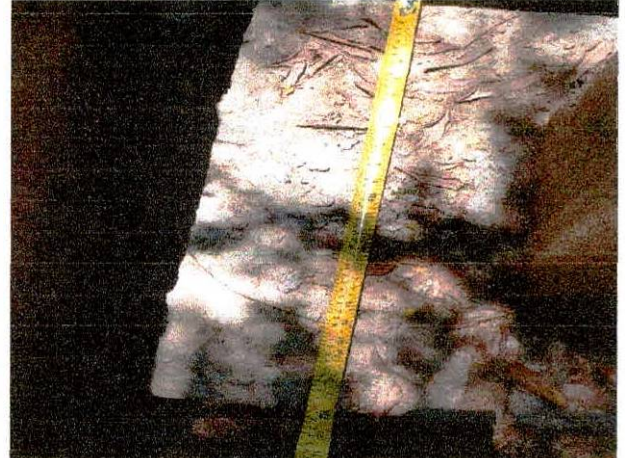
Escavação/Sapata isolada 60 x 60 cm
